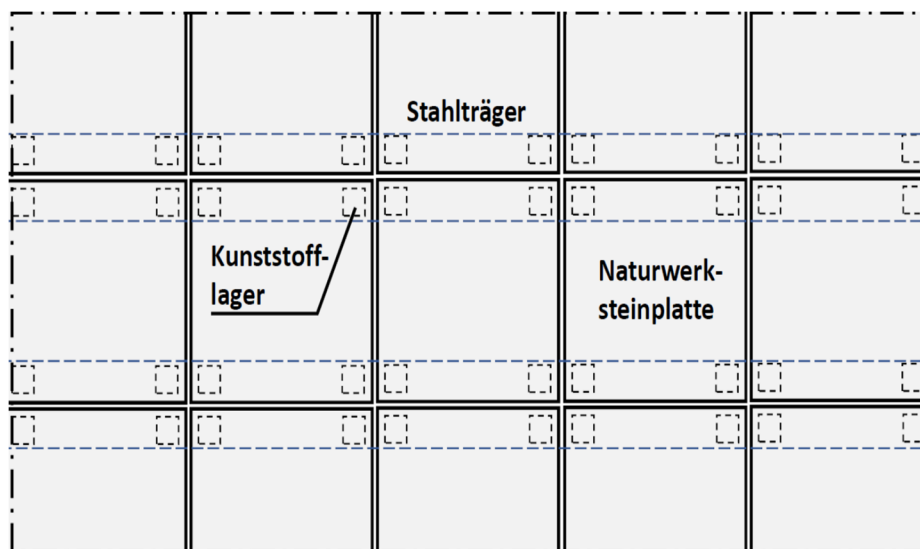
Ausführung auf einer Stahlunterkonstruktion
